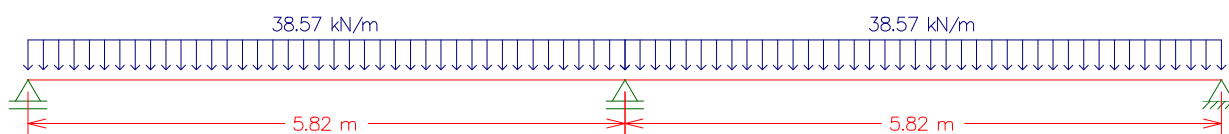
Esquema Estrutural - Viga 9 (Cobertura)
